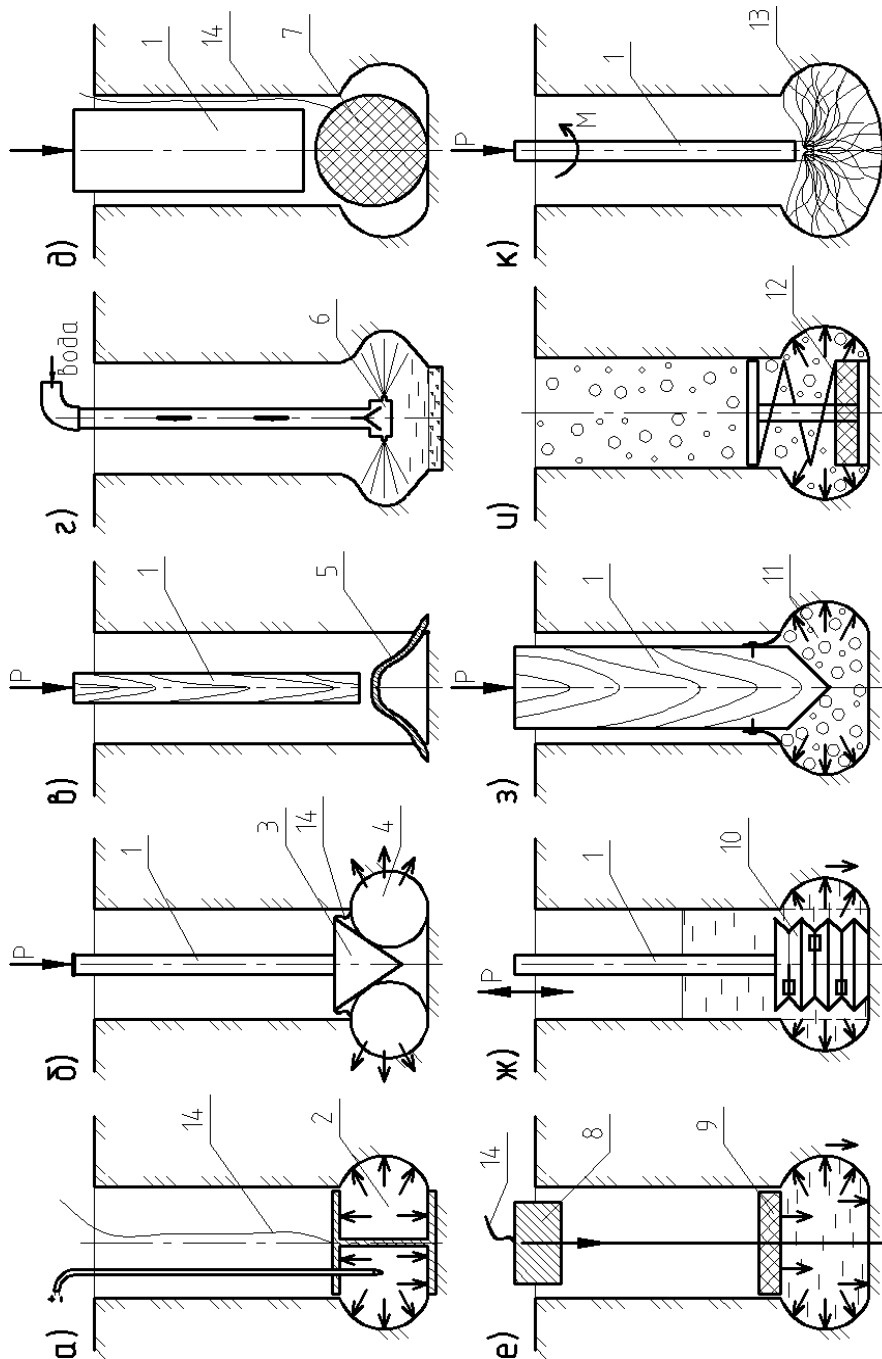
Прогрессивные конструкции устройств и приспособлений для образования уширений в забое скважин:
